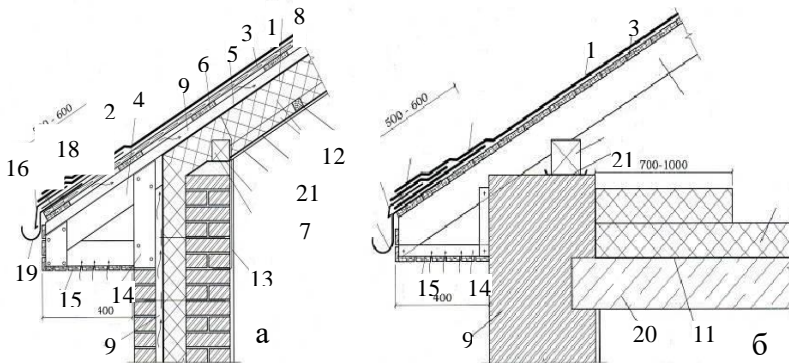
Схема карнизного вузла даху із гнучкої черепиці: а – мансардний поверх; б – холодне горіще; 1 – гнучка черепиця; 2 – підкладний шар; 3 – суцільний настил; 4 – кобилка; 5 – повітрязахисна дифузійно-гідроізолювальна плівка; 6 – лати; 7 – мауерлат; 8 – кроква; 9 – вентиляційний проміжок; 10 –
